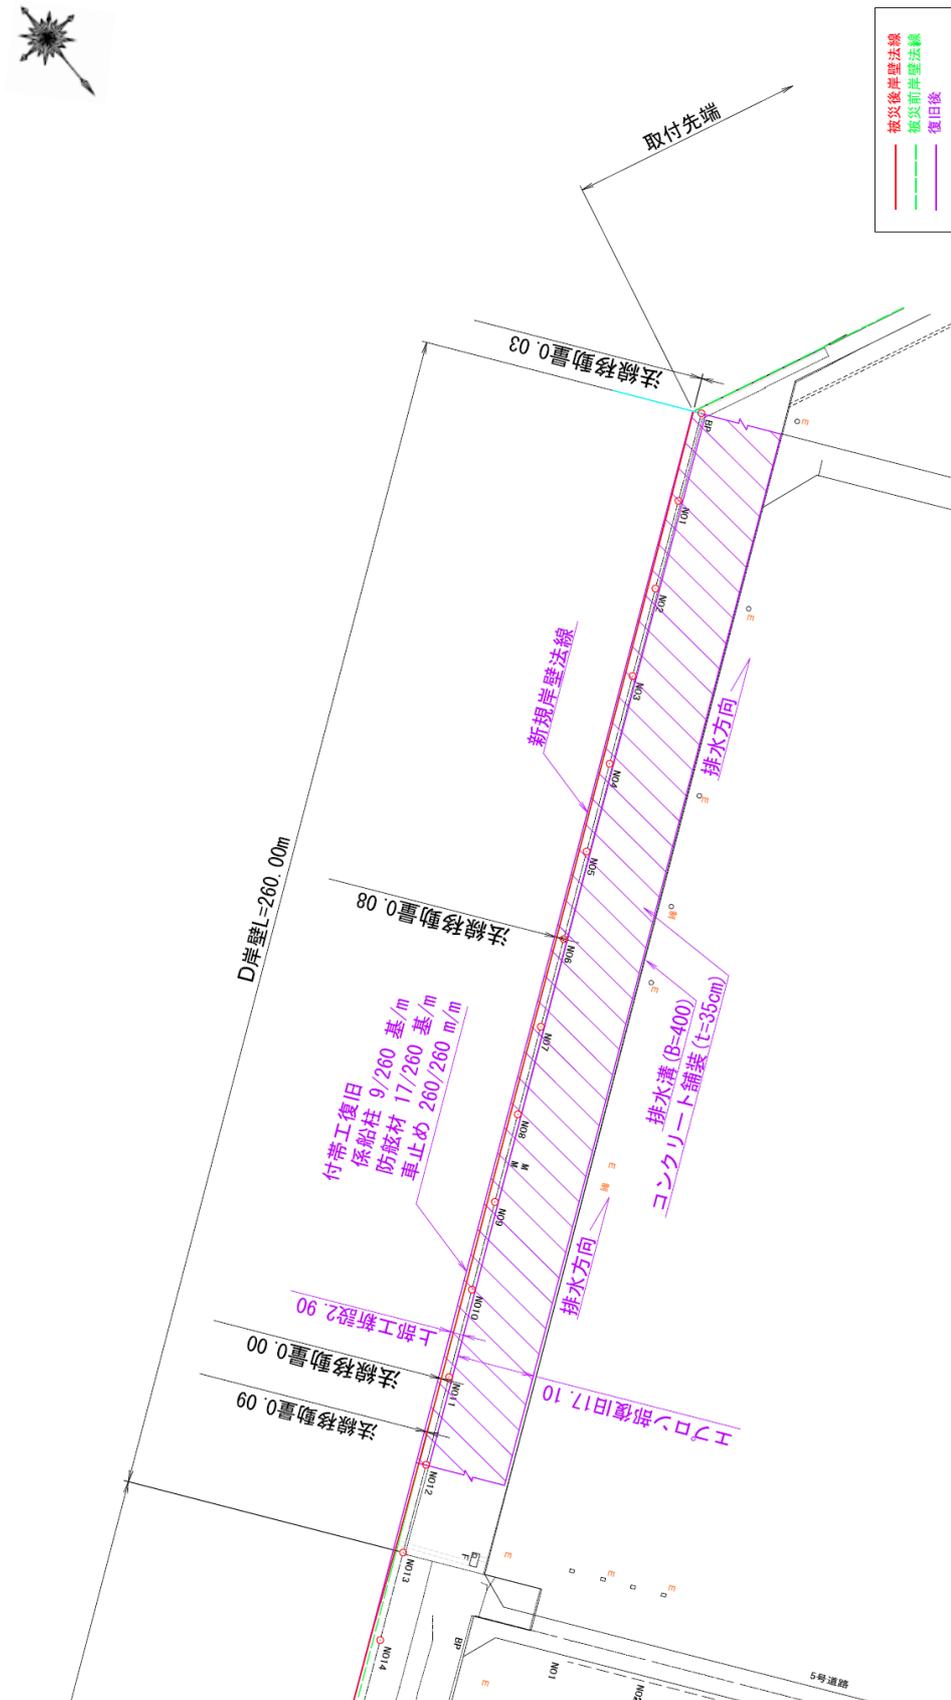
No.12 日立港区_第5埠頭地区 5-D岸壁 (-12m) の平面図 (被災後・復旧後)
